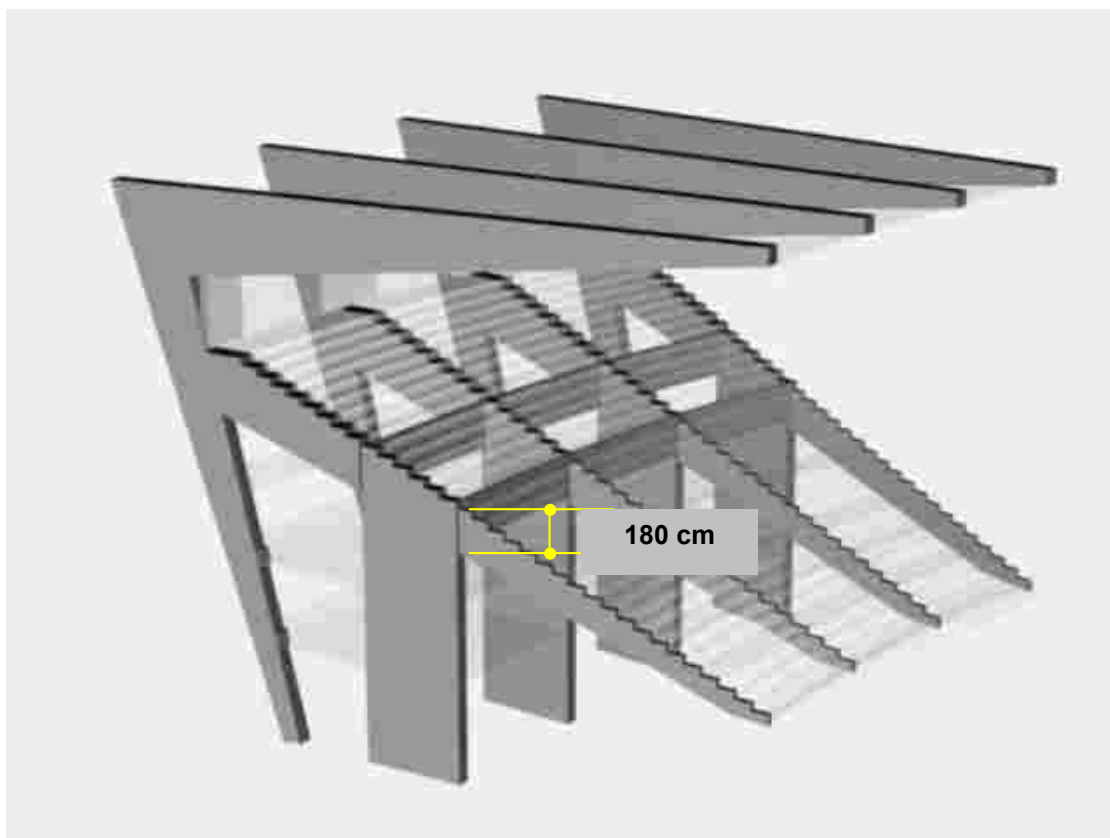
Croquis do projeto original do pórtico do setor 15, que serviu de piloto para a construção
